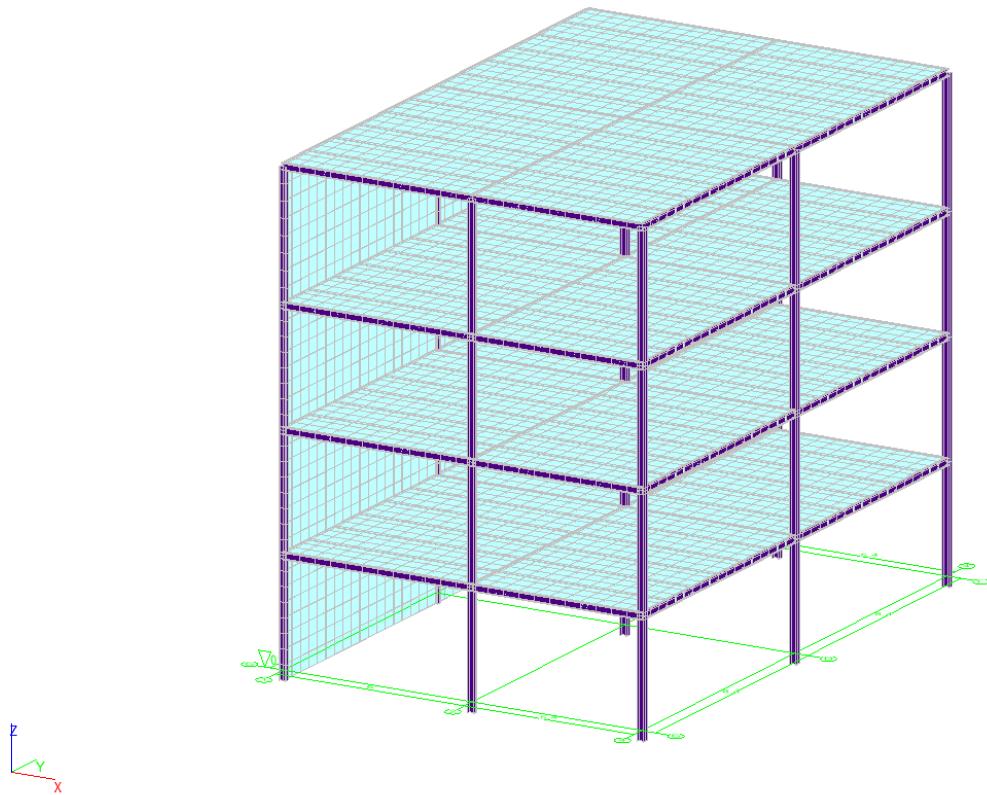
Расчётная схема поперечника (Каркас с объёмом элементов)
